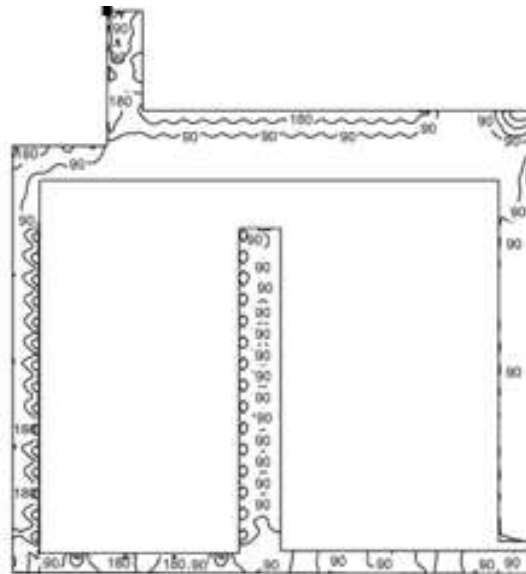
ANEJO II: ILUMINACIÓN - Planta exterior
